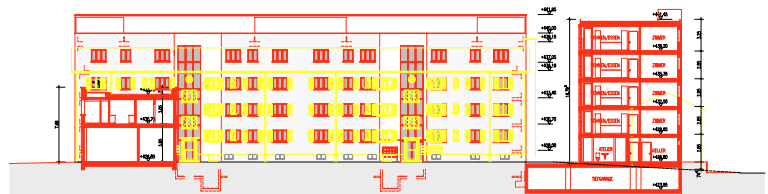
Schnitt durch die südlichen Zwischenbauten und Grundriss der Wohnüberbauung
